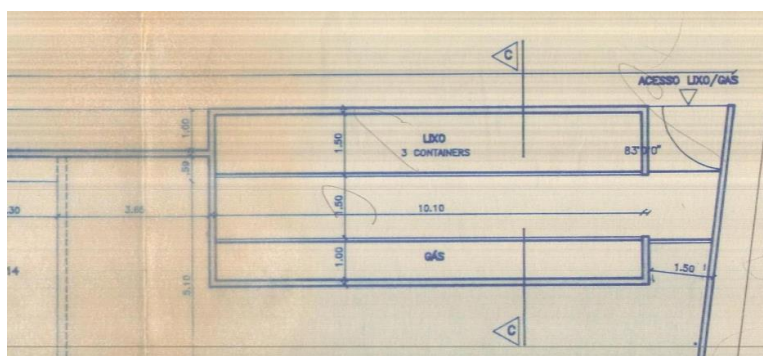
Recorte da Planta Baixa do Térreo do Edifício Camille Frammarion. Fonte: Arquivo da Prefeitura de Recife (1998).
